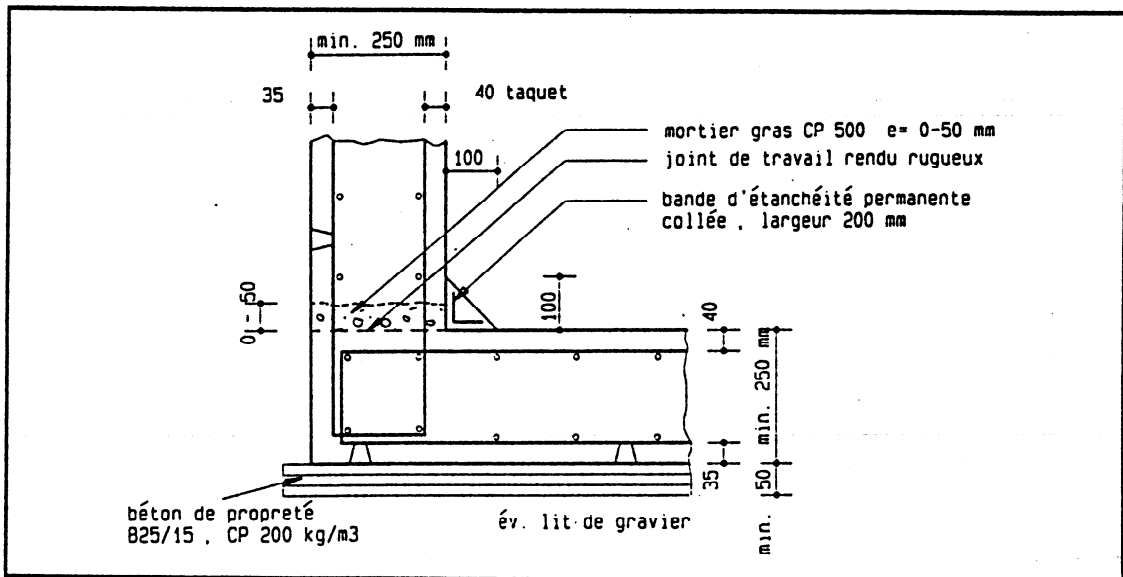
Sol / paroi, bande d'étanchéité collée
